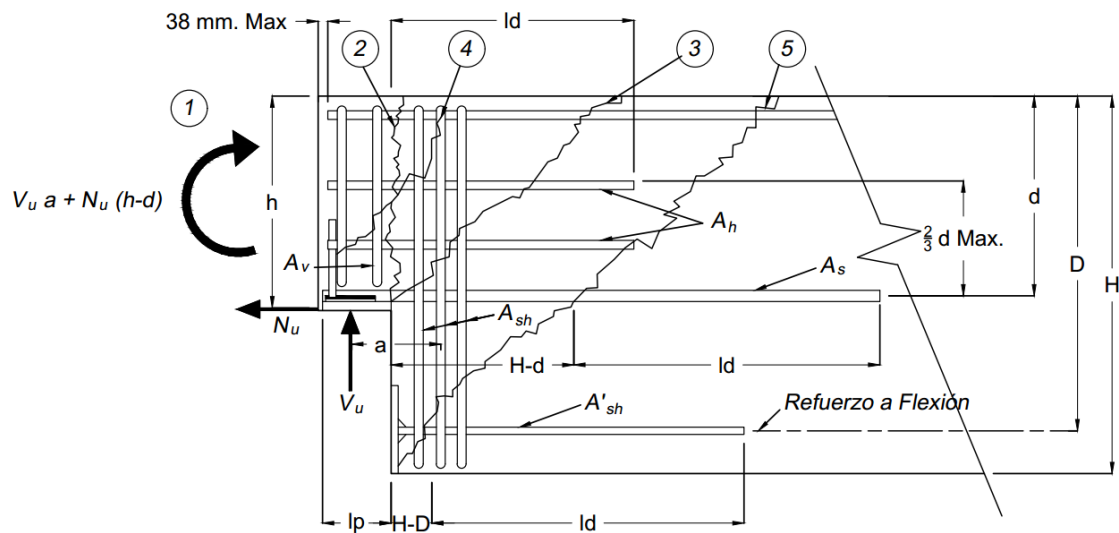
Grietas potenciales según la falla en una viga con extremos recortados fuente (PCI, 2004)
